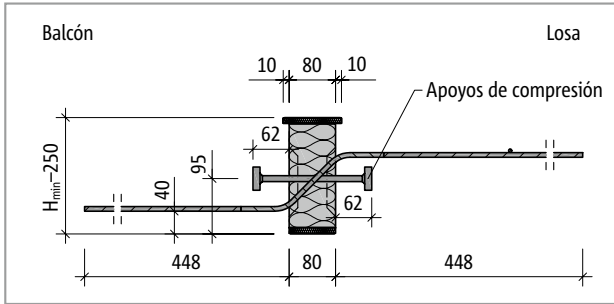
Schöck Isokorb® T tipo Q-P-V1 hasta Q-P-V3: Sección del producto
